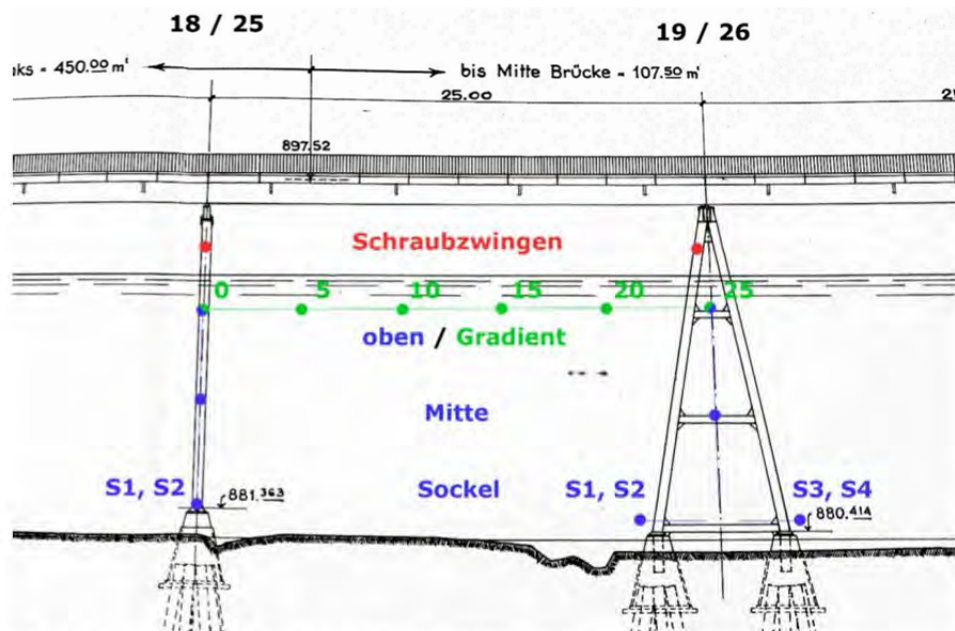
Planausschnitt mit eingezeichneten Messpunkten.
